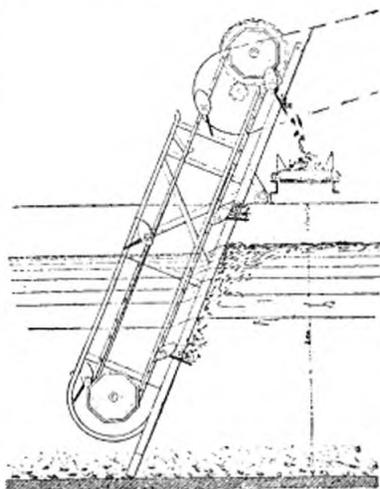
Grille avec râteau mécanique Dutoit pour arrêter les fumiers des égouts de Paris.
